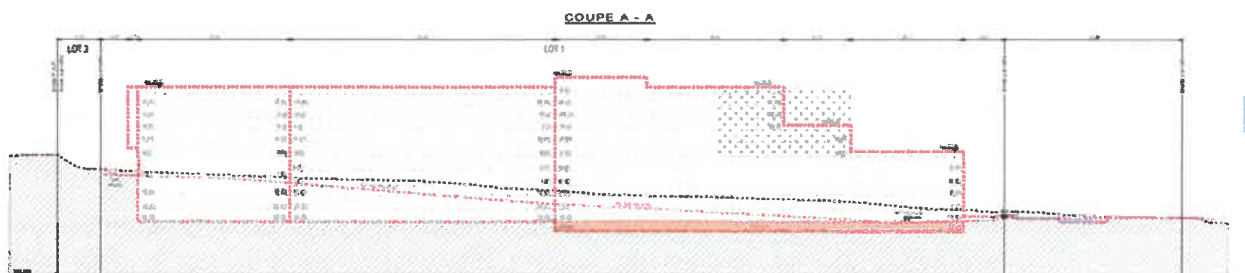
Ausschnitt aus der geplanten Modifikation des Plan d'aménagement particulier - Coupe A-A, vgl. Kap. 5.2 (Quelle: BEST S.à r.l. 2023).
